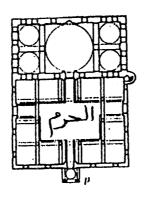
مسقط أفقي لمسجد طلختان بابا قرب مرو.) (عن: Kuban).
